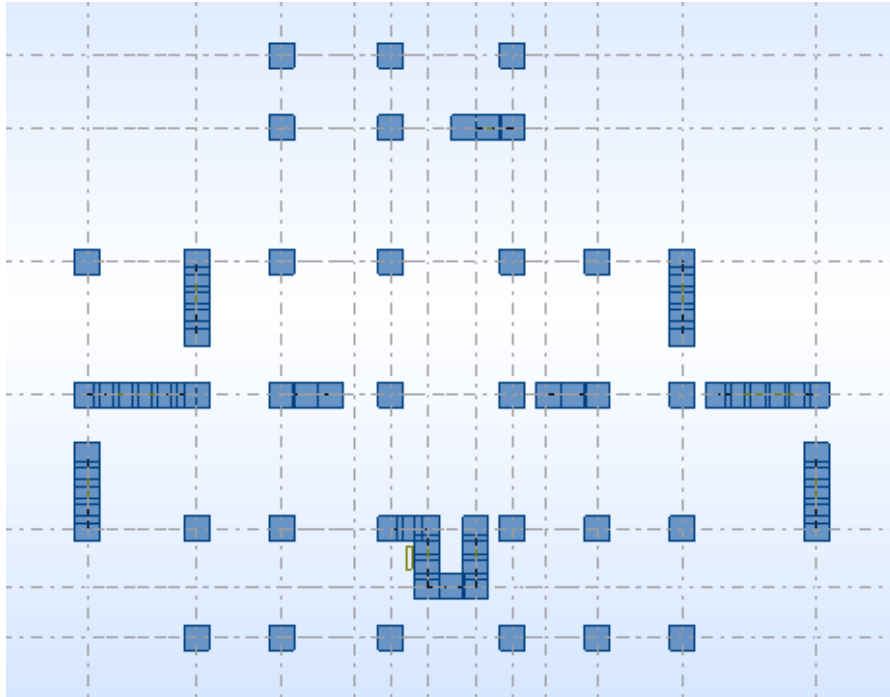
Disposition des voiles de la 1^{er} proposition
